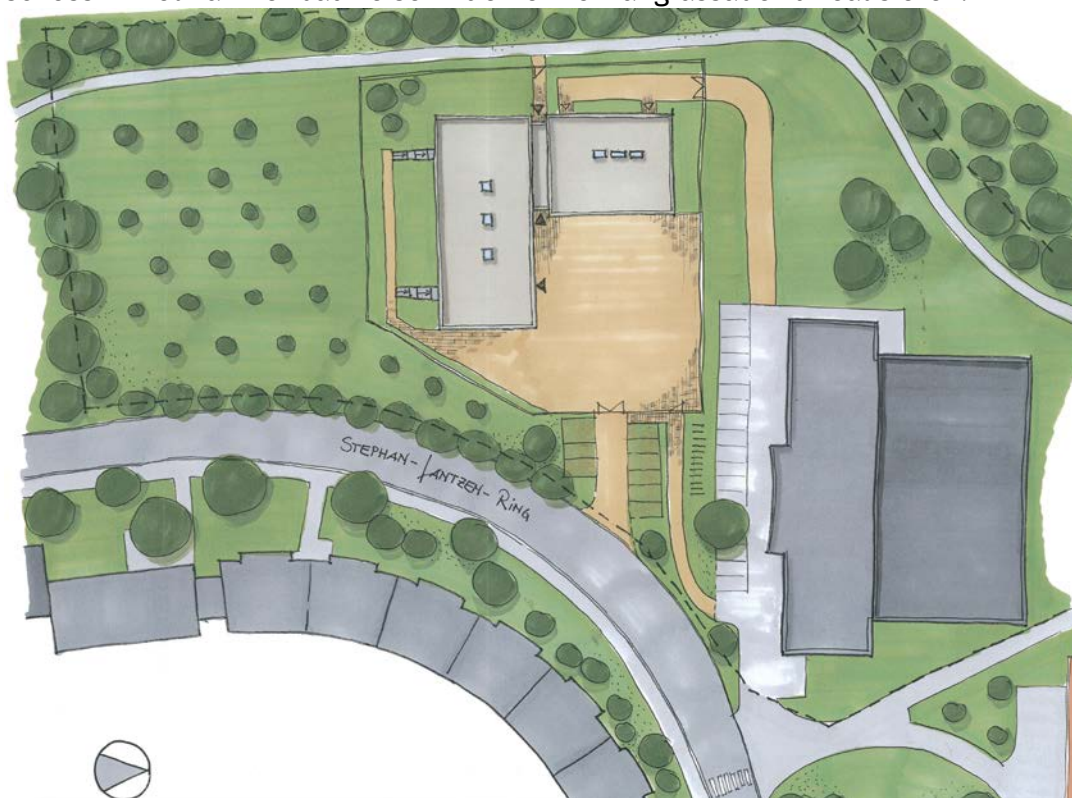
Entwurf Lageplan, Quelle: B3 Architekten Ingenieure GmbH
